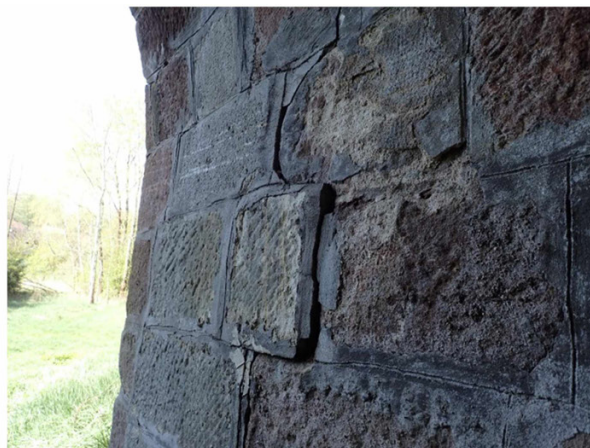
O 02, 1,08 m zleva detail výsunu kvádrů a boulení.
